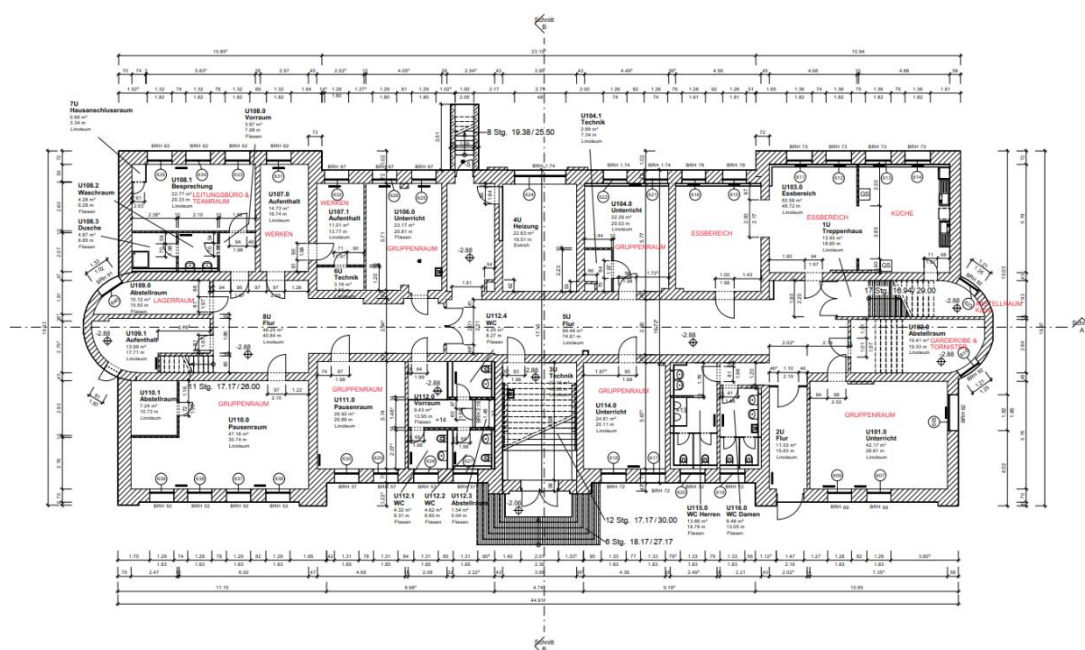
Grundriss KG des Bestandsgebäudes
